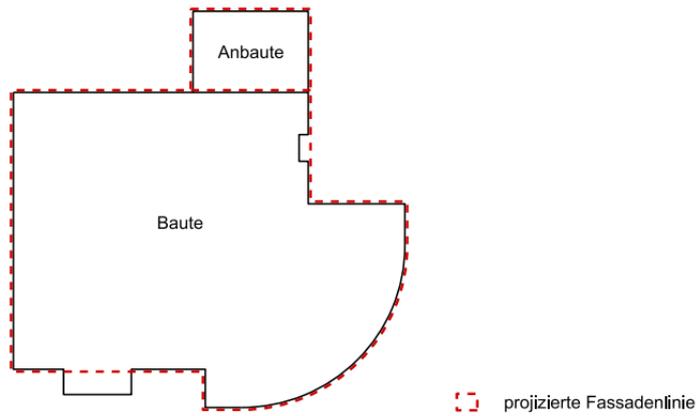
Gebäudelänge und Gebäudebreite (§21)
